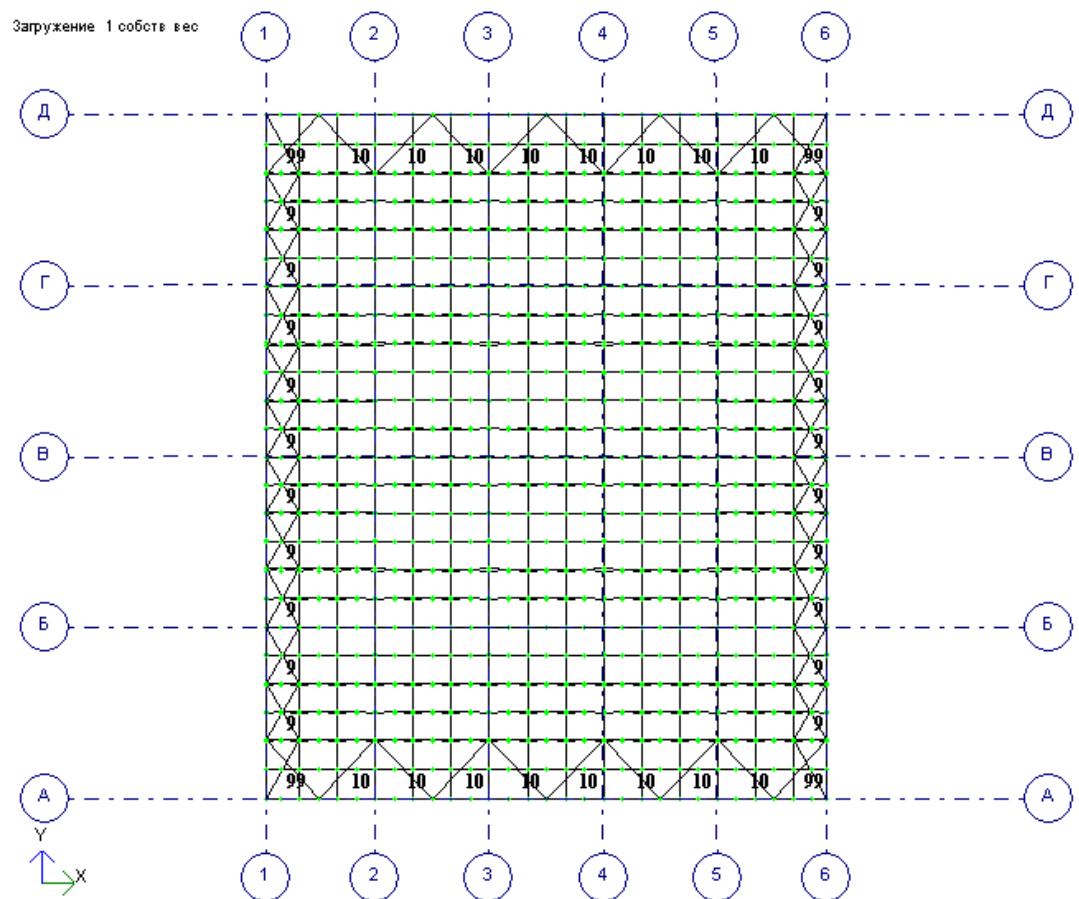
Схема связей по нижнему поясу ферм
